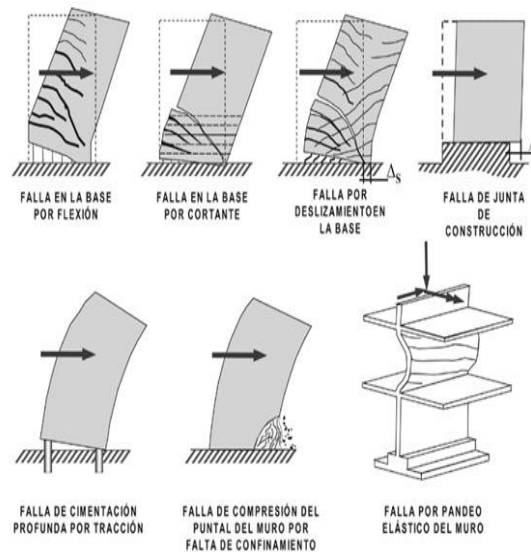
Tipos de falla en muros de albañilería (Fuente: Materialesparaconstruir.blogspot.com)
